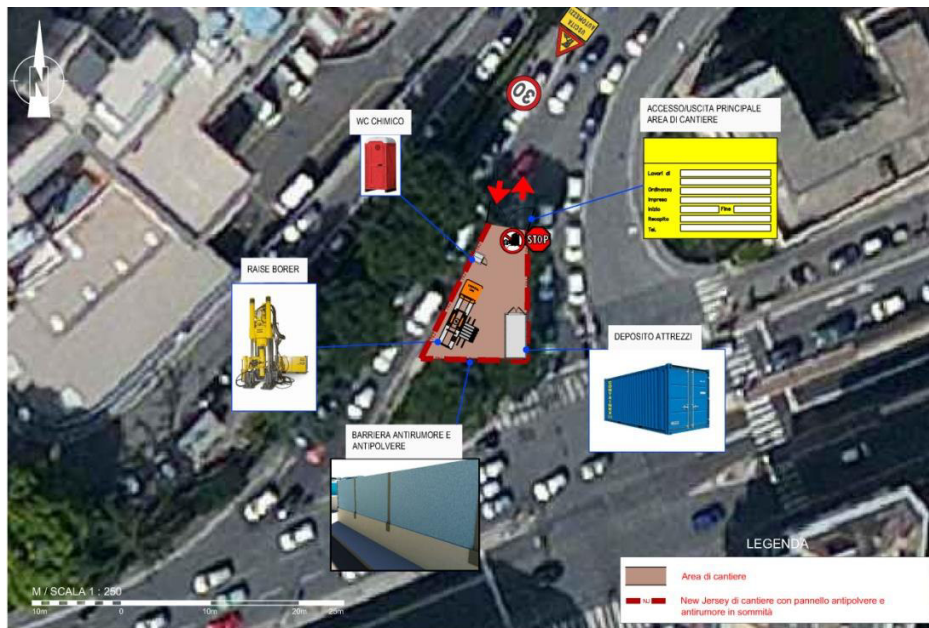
Planimetria cantiere aeroforo Giardini dell'ospedale Generale di San Martino
